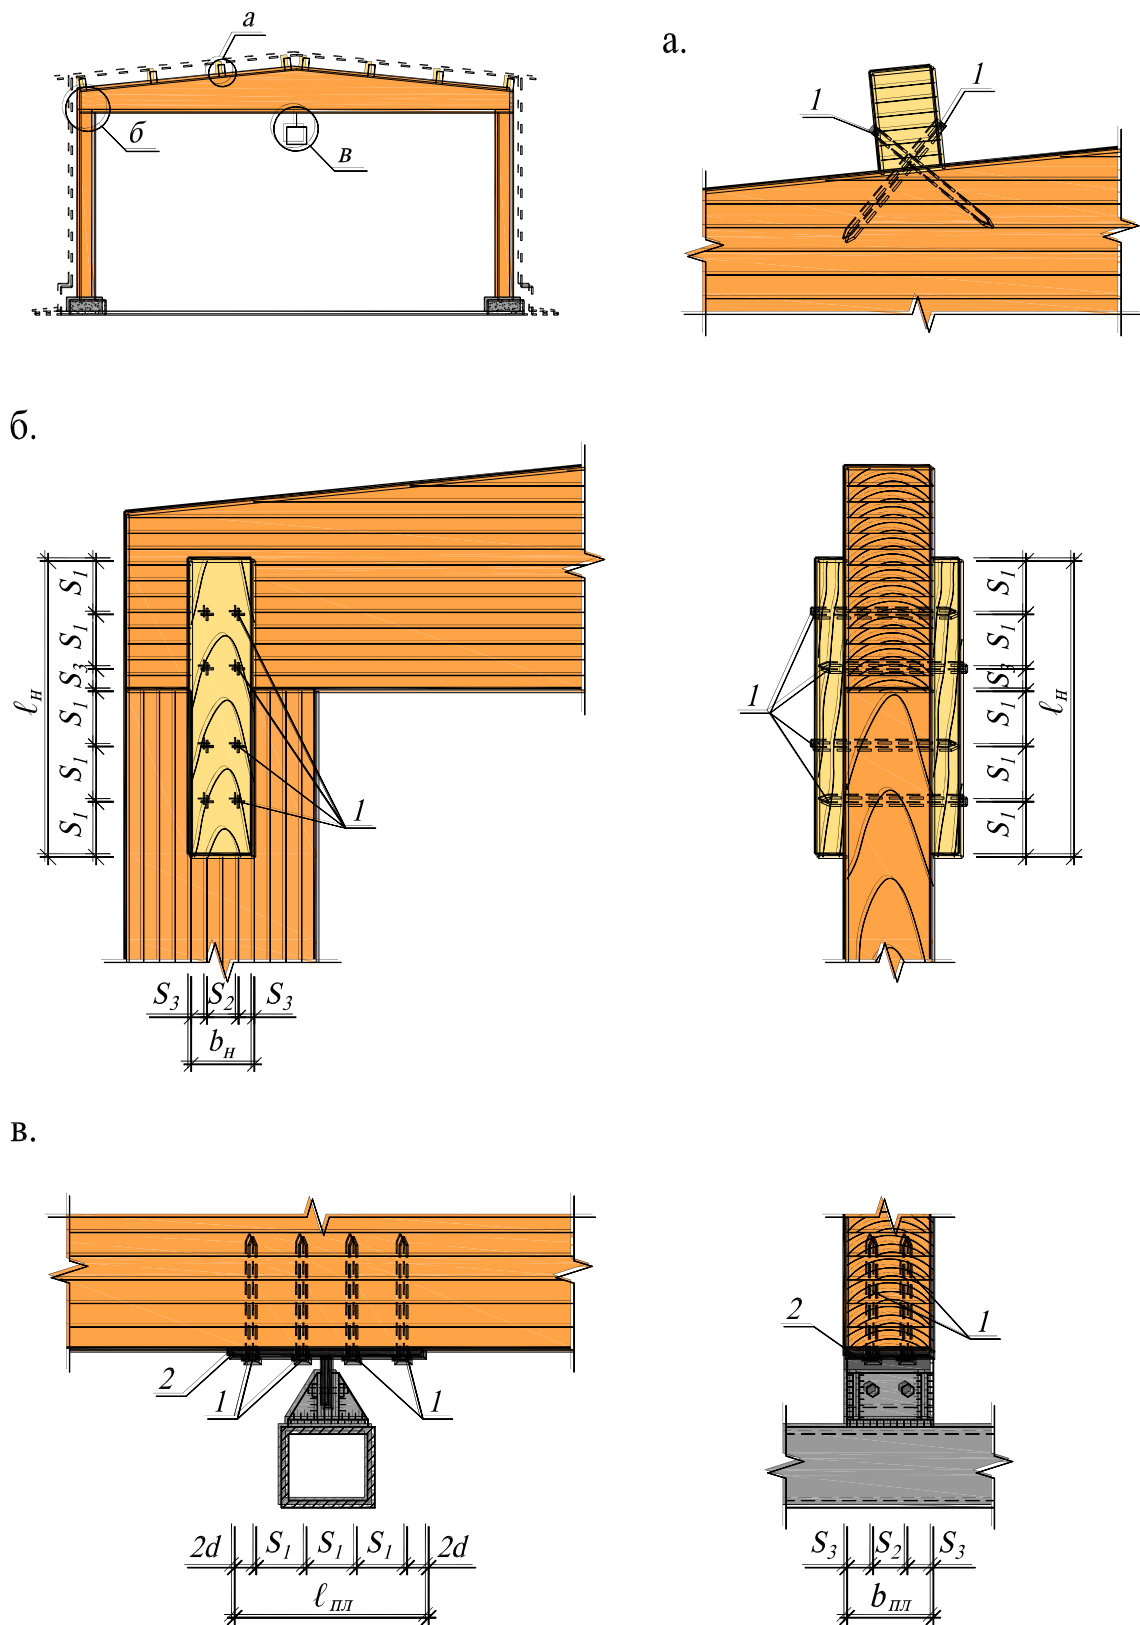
Простейшие узлы каркасного деревянного здания на витых стержнях крестообразного поперечного сечения:
